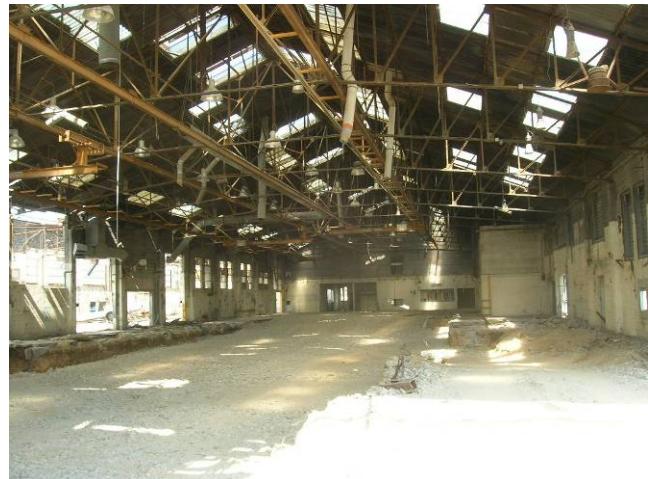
dépose des éléments de toitures en amiante ciment au droit de la zone 2
